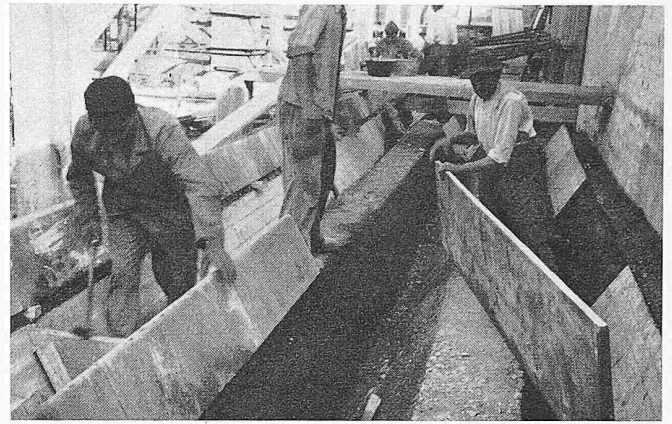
Verlegen der vorfabrizierten, dreieckigen Höcker (obere Kante abgerundet)
